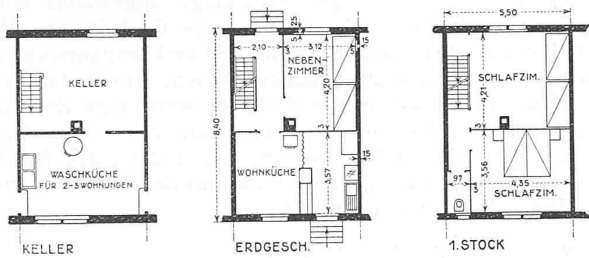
Grundrisse der Reihen-Einfamilienhäuser, 1 : 300.
